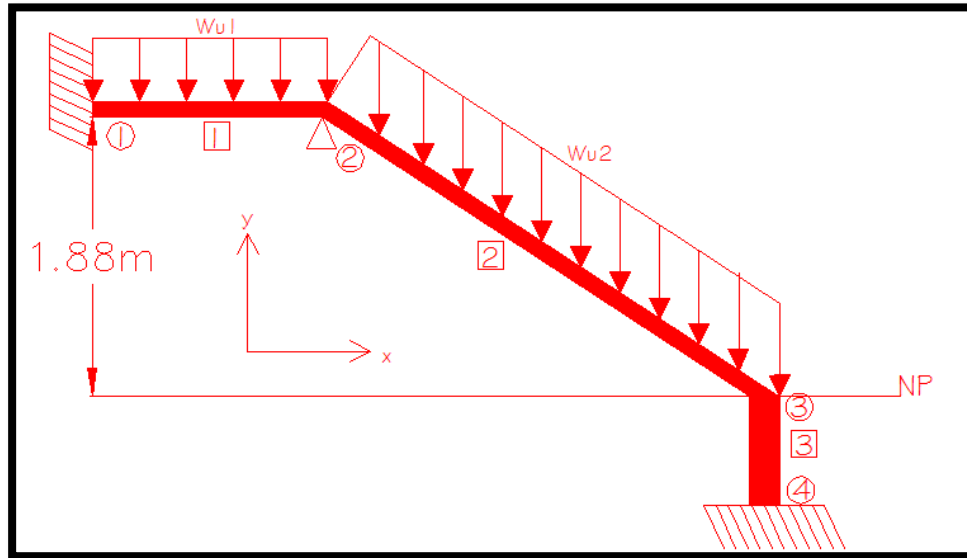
Modelo de escalera con cargas muerta y viva aplicadas sobre las vigas.
